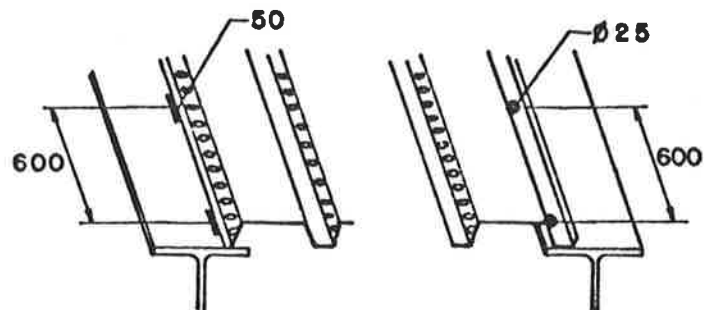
Soldagem longitudinal dos perfis extremos.
